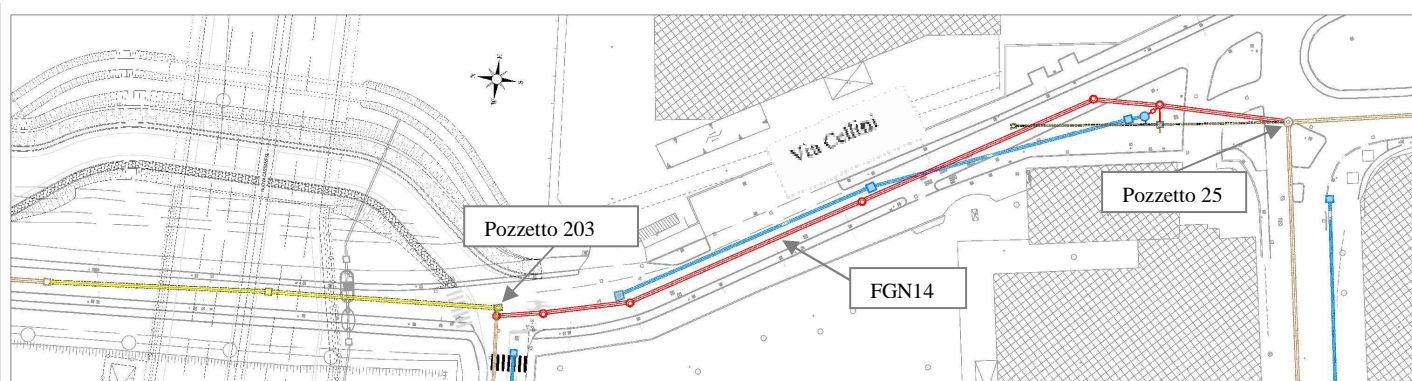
Interferenza FGN 14 – Planimetria di progetto
